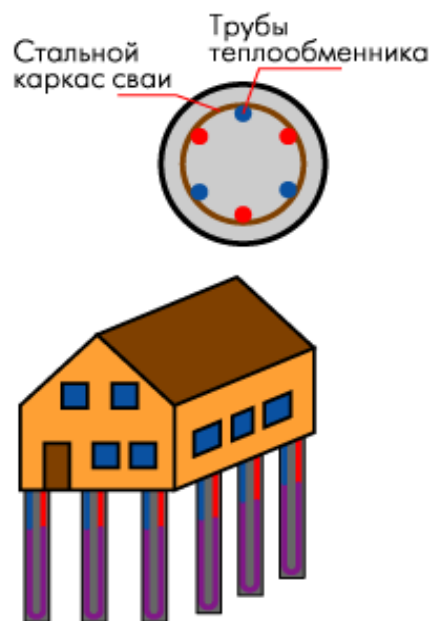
Схема грунтовых теплообменников, замоноличенных в фундаментные сваи здания, и поперечное сечение такой сваи
